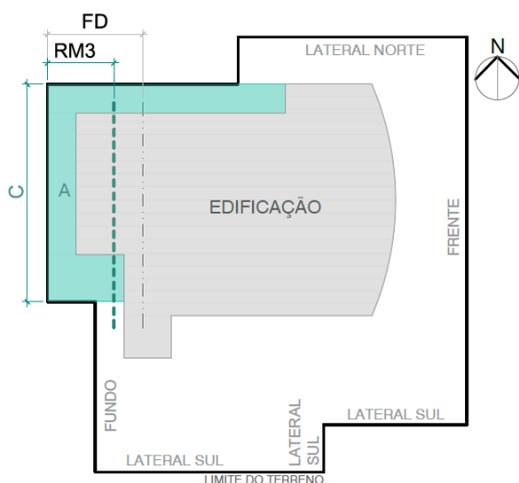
Planta demonstrativa do recuo médio da 2ª face da fachada norte
